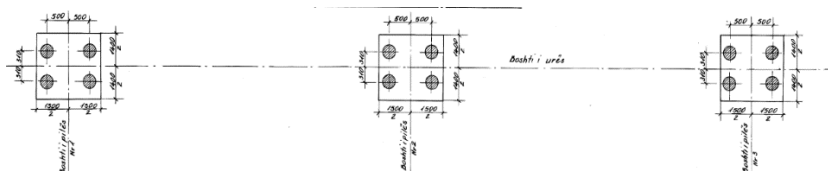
Planimetria. Prerje horizontale në risegën e plintave ([6])
